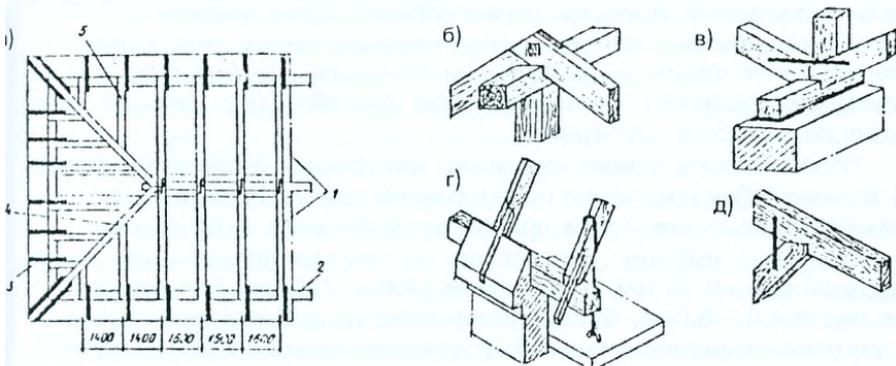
Фрагмент плана крыши и узлы наклонных стропил.
